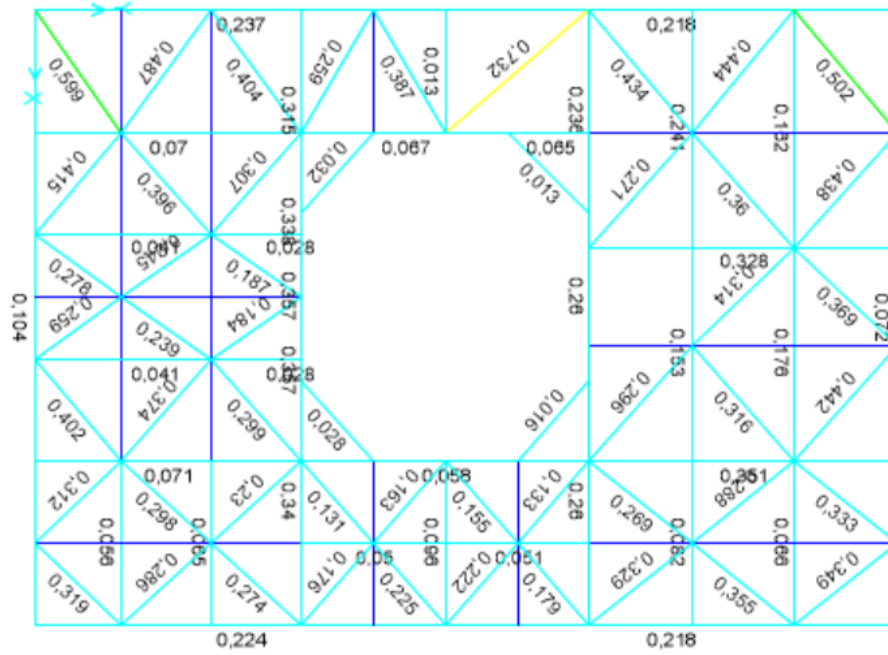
Factores de utilización vista en elevación 12.04 [m] sobre nivel de terreno.
